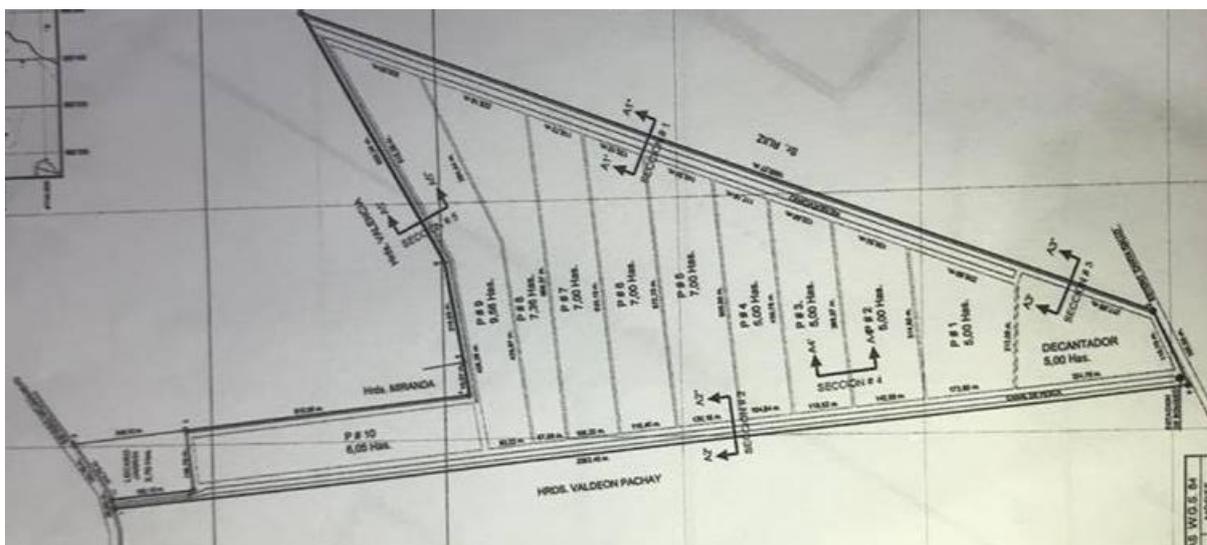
Levantamiento Planimétrico del sector B de la camaronera.
